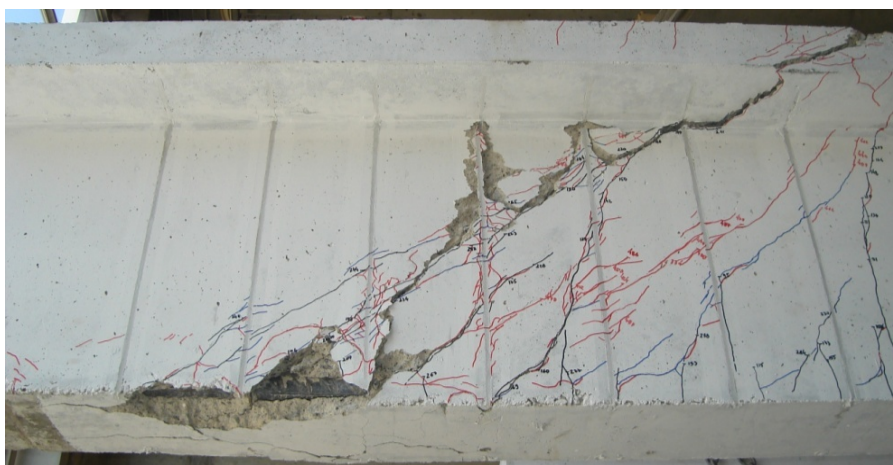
Pormenor do modo de rotura da viga 3S-7LV-C.
